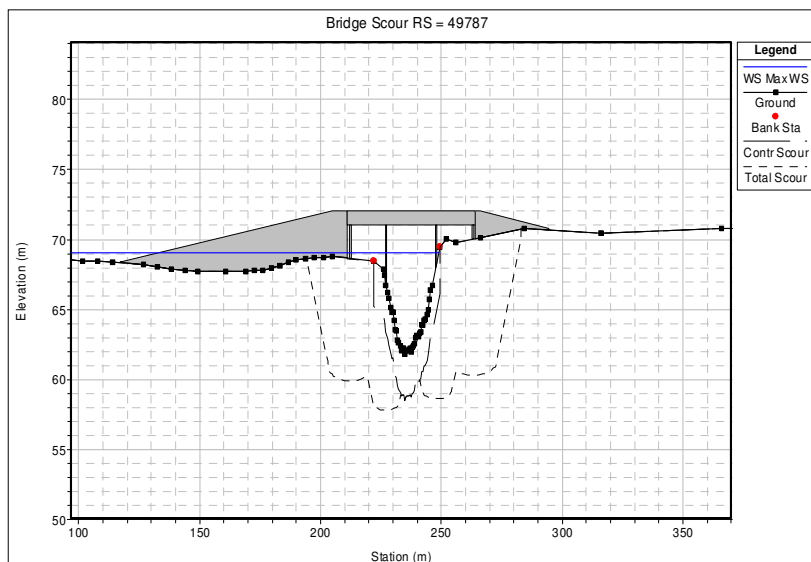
Puente en Piedra Grande - Perfil Transversal erosionado – d50: 0.50mm
